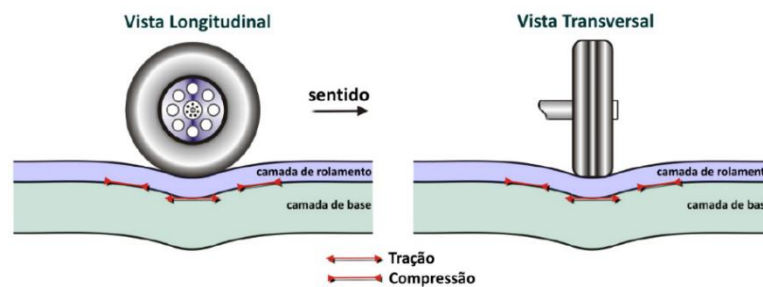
Tensões em um pavimento asfáltico submetido à carga de roda
